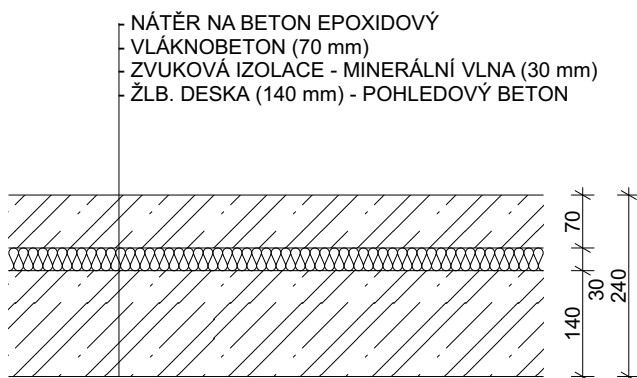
Podlaha předsazených konstrukcí - zateplená (1:10)
